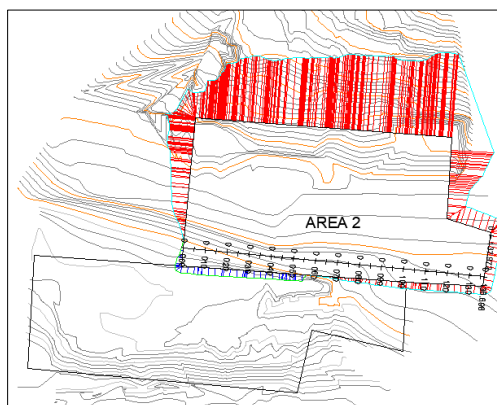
Rencana Area Cut and Fill Total Station
